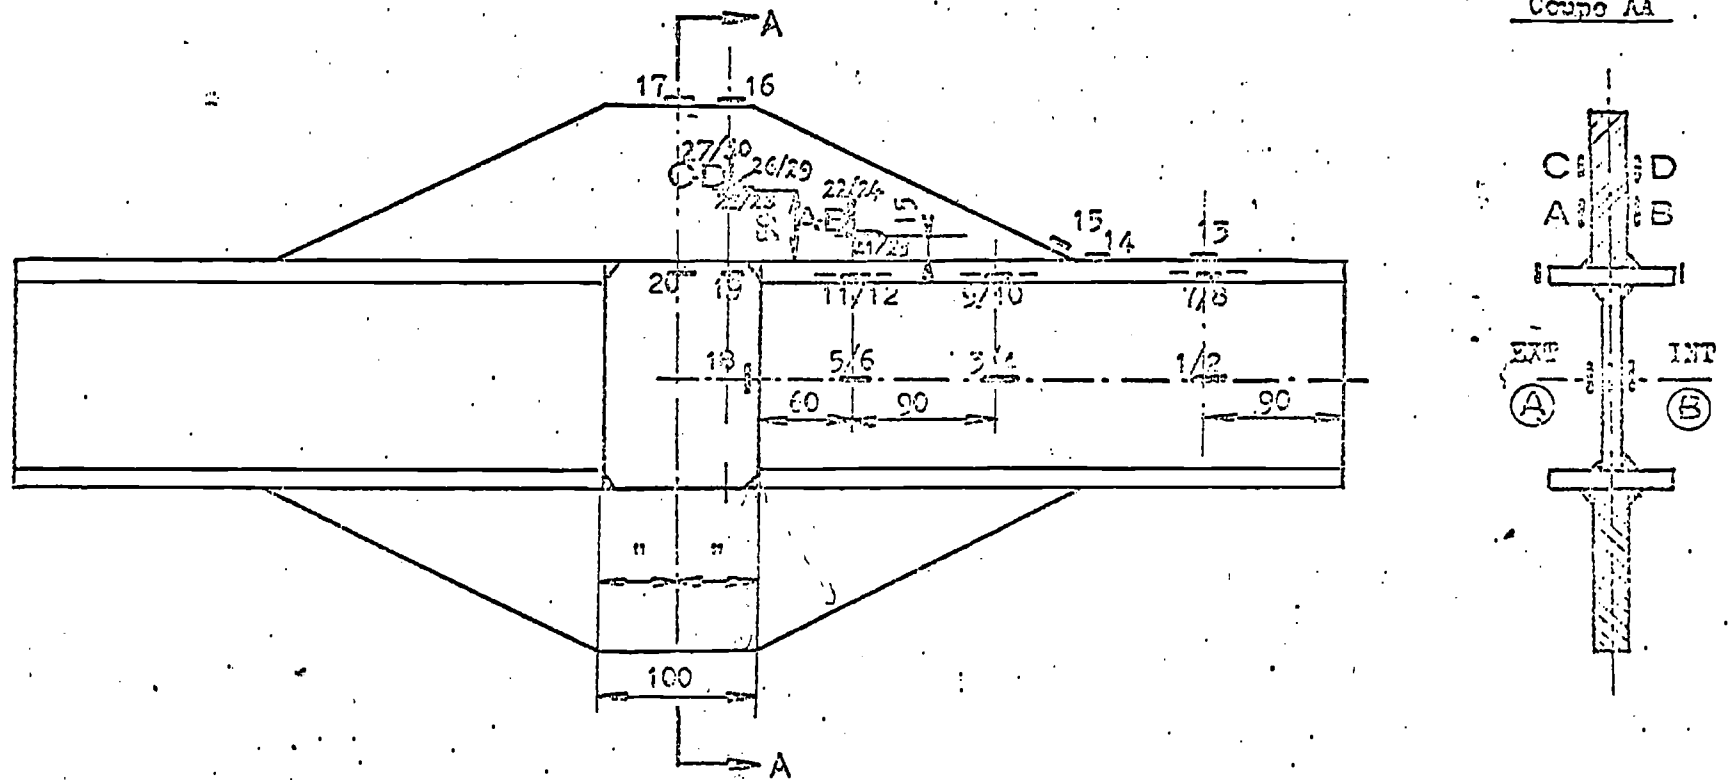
Position des jauges pour l'éprouvette type A - (repère MSN : 6).
